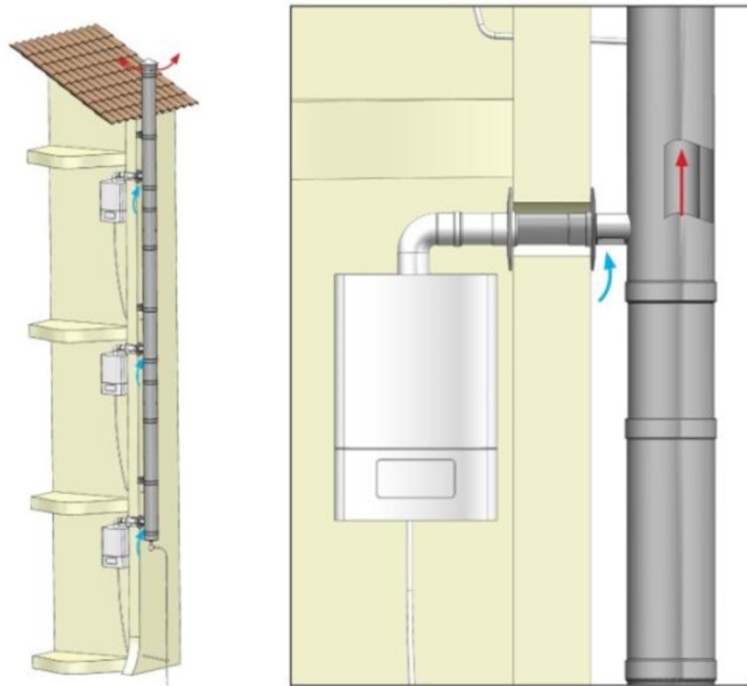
Principe de montage de la version DINAGAS 3CE+ DW à l'extérieur d'un bâtiment
